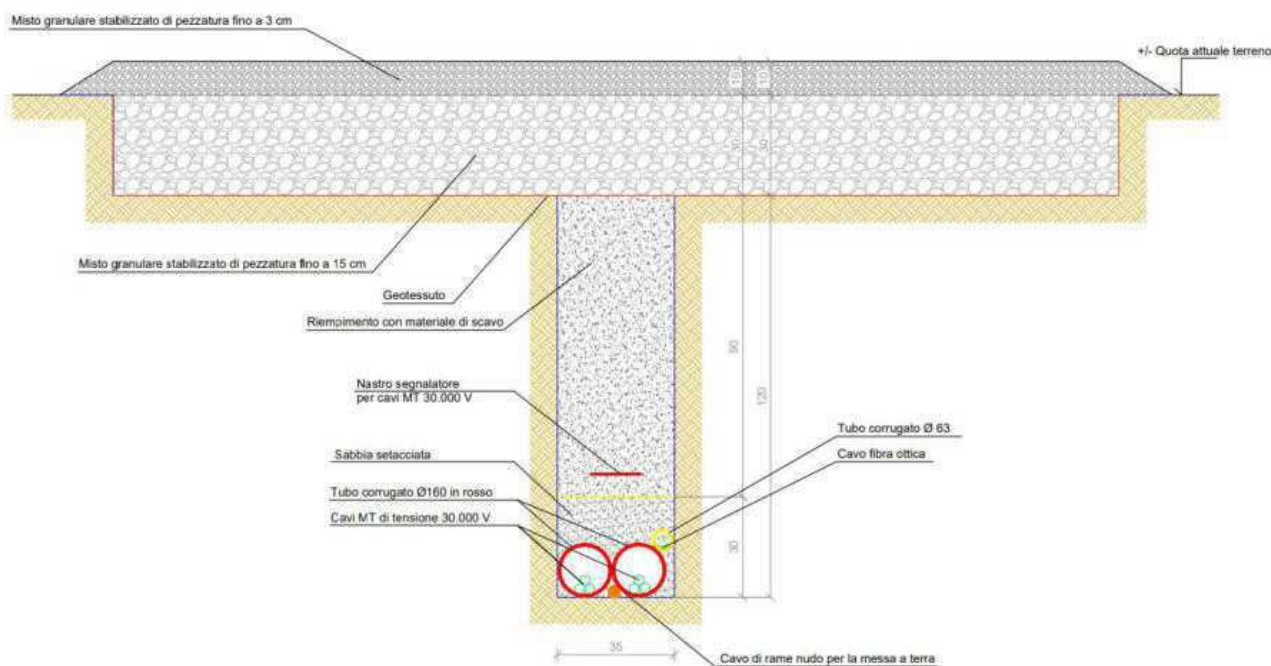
SEZIONE DELLA STRADA E DEL CAVIDOTTO MT – TIPO 1
